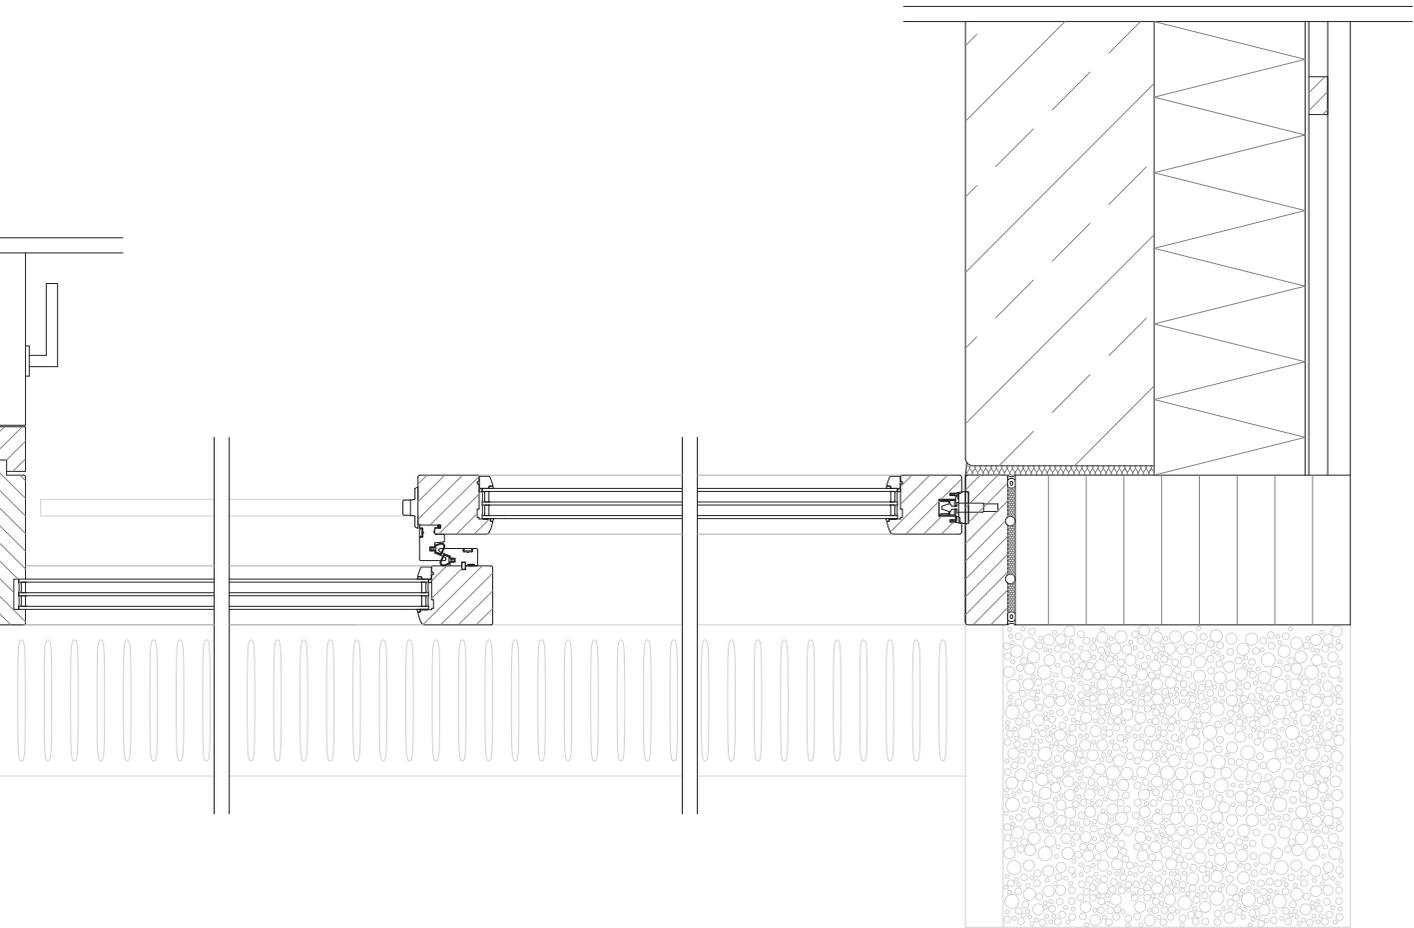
Horizontalschnitt Glasfassade EG M1:20
